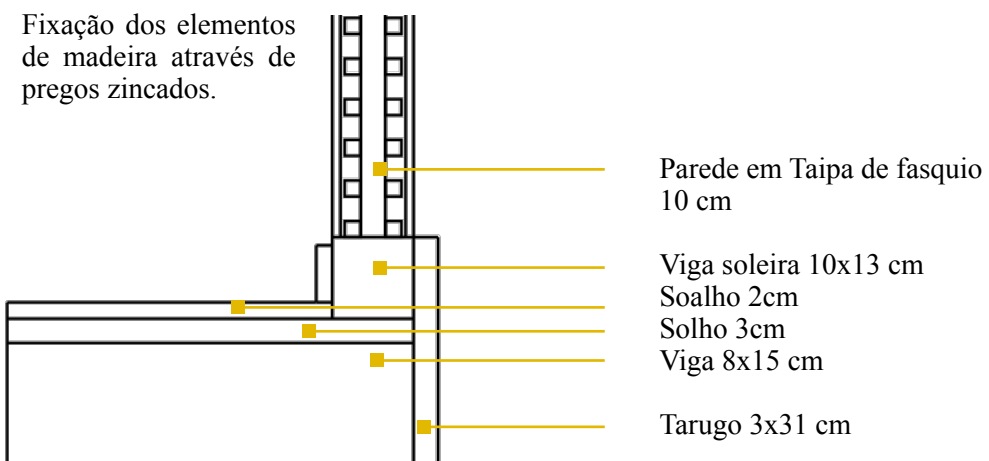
| Exemplo de um detalhe construtivo de uma parede em taipa de fasquio - tabique.
